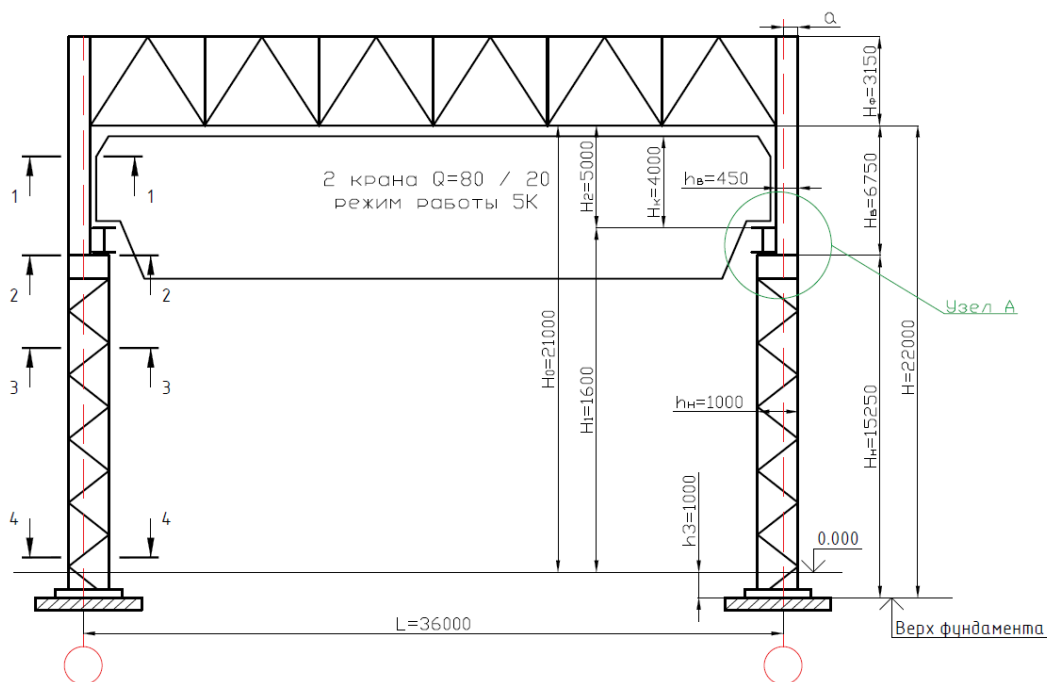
Поперечный разрез однопролётного каркаса цеха промышленного здания
